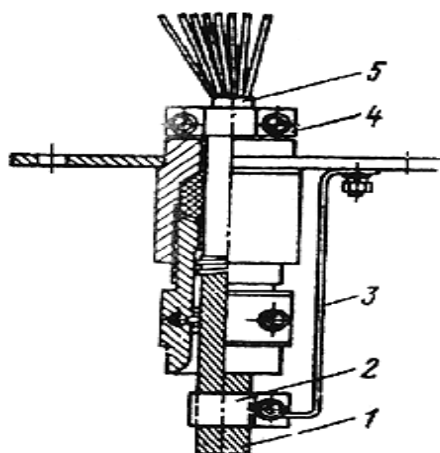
Схема заземления контрольного кабеля со свинцовой оболочкой:
